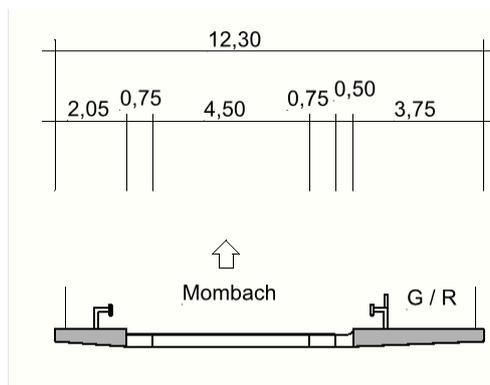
Querschnitt Ausfahrrampe Wiesbaden - Mz-Mombach Bauwerk
